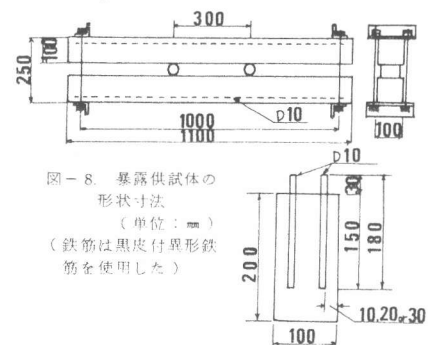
暴露供試体の形状寸法 (単位: mm) (鉄筋は黒皮付異形鉄筋を使用した)
